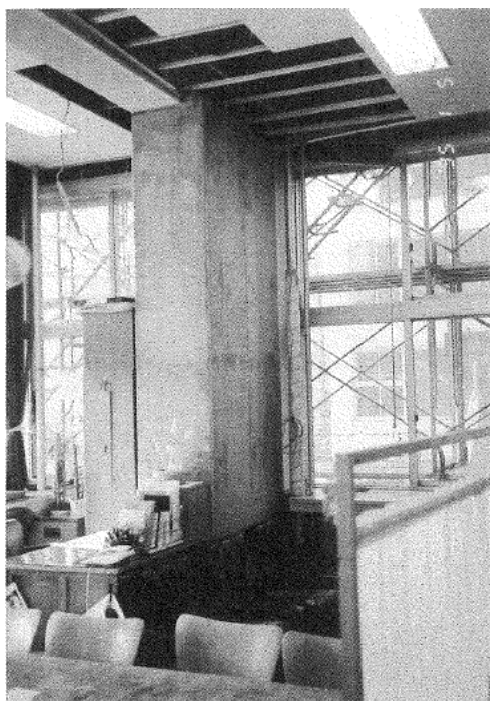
大破した鉄筋コンクリート造柱に添わせて十分大きな鉄筋コンクリート造柱を増設した応急補強の例
